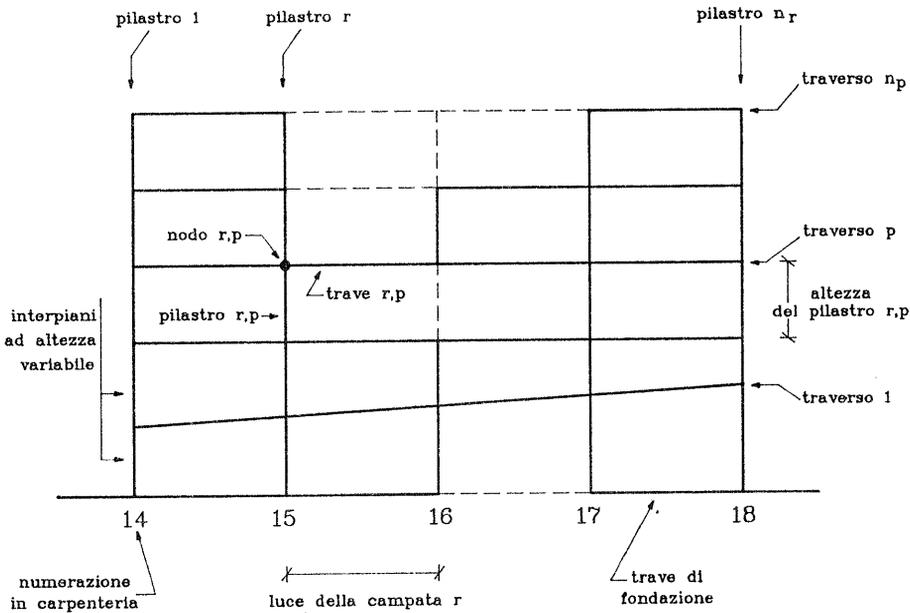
Telaio a maglie trapeziche con trave di fondazione ed aste mancanti
